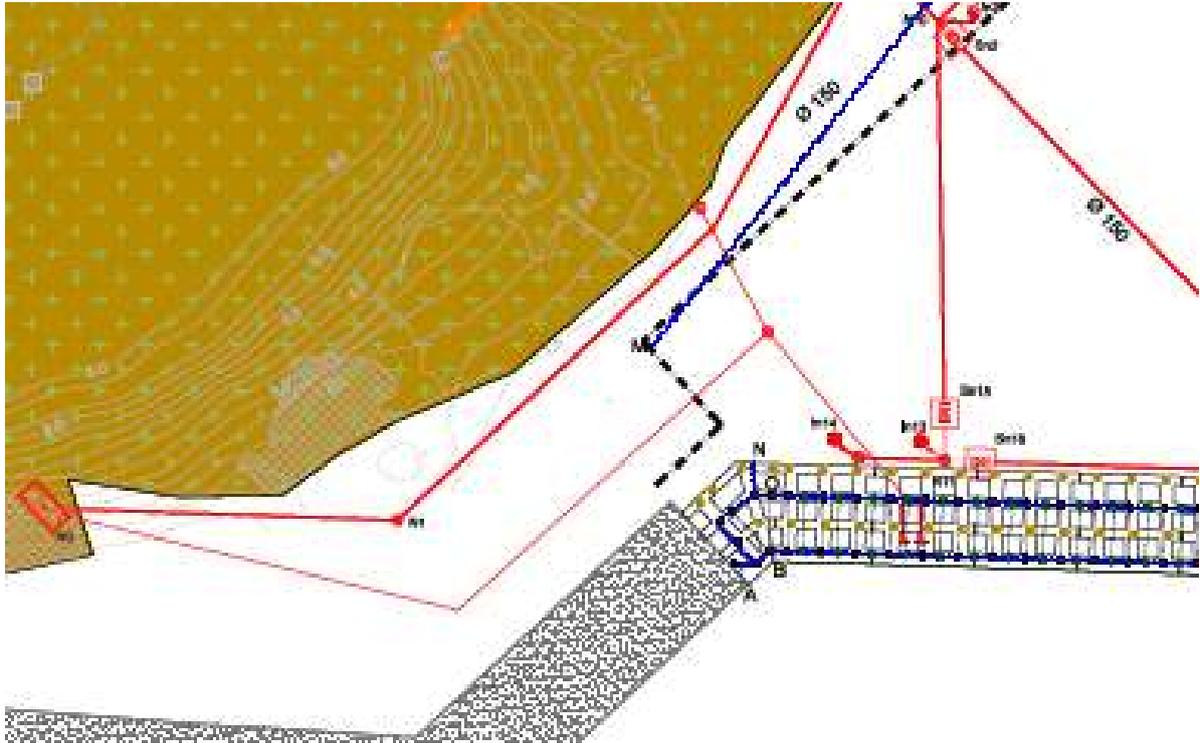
Planimetria rete antincendio Progetto Esecutivo – Particolare tratto oggetto di modifica
